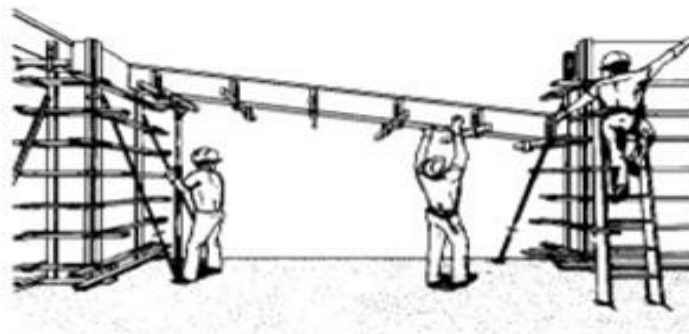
Montagem dos painéis de cofragem em vigas
